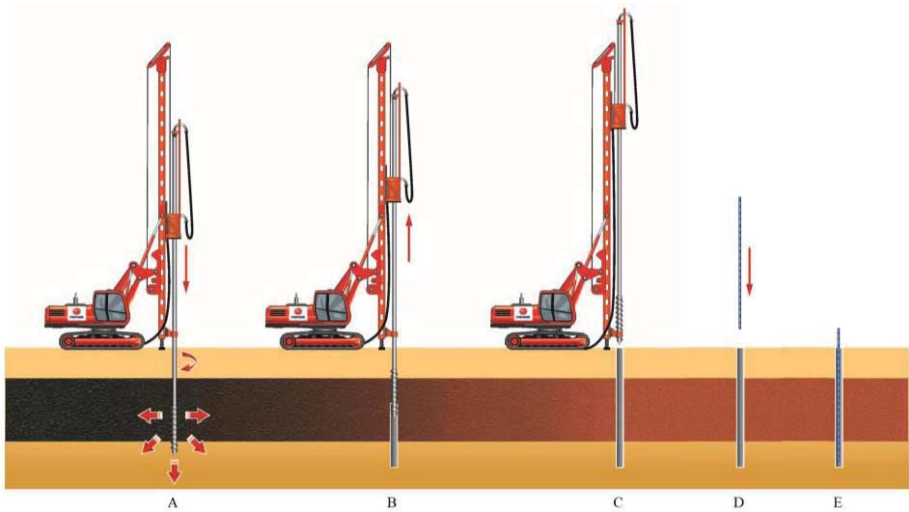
Secuencia constructiva general de una CMC reforzada. A) Perforación; B) Extracción de la barrena y colocación del concreto; C) Fin de colocación de concreto hasta la plataforma de trabajo; D) Instalación de armadura de acero de refuerzo E) Fin de construcción de CMC reforzada.
